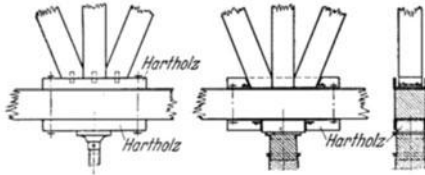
Auflagerknotenpunkt in einem Lehrgerüst. Einschaltung von Hartholz- oder -Stahlstücken (nach Mörsch 10b).
